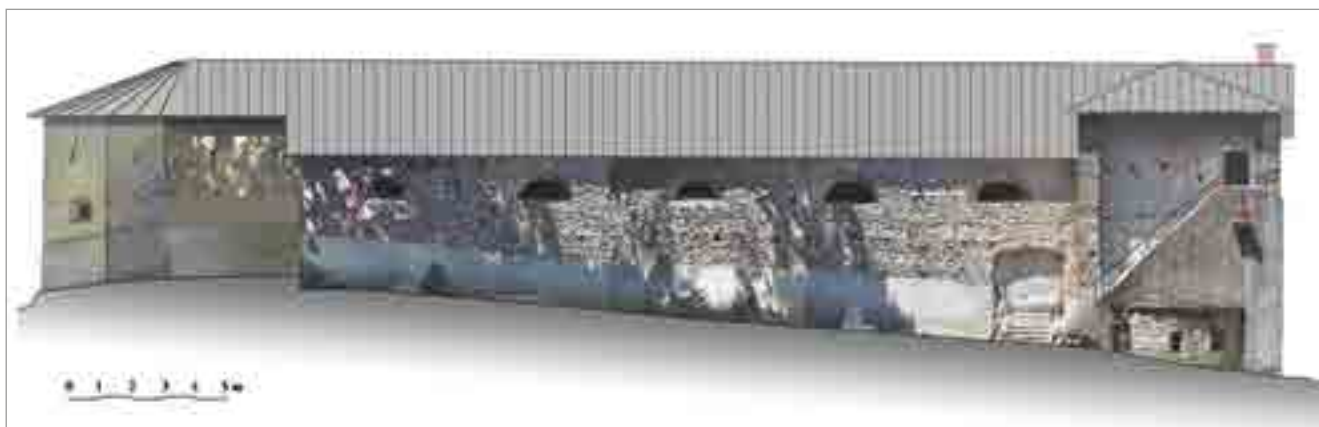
Prospetto di levante del complesso con fotoraddrizzamento (Bergamini, luglio 2015).
